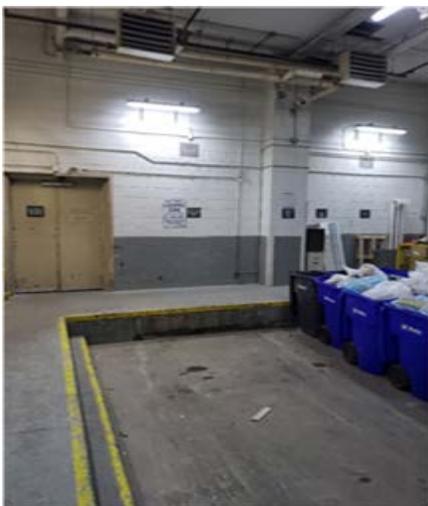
Photo de la porte du quai de chargement avec vue sur l'intérieur de la zone du quai de chargement
